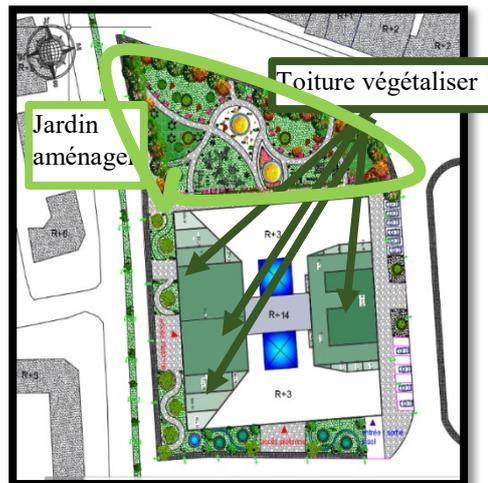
la végétation sur le plan de masse (source : auteur).
